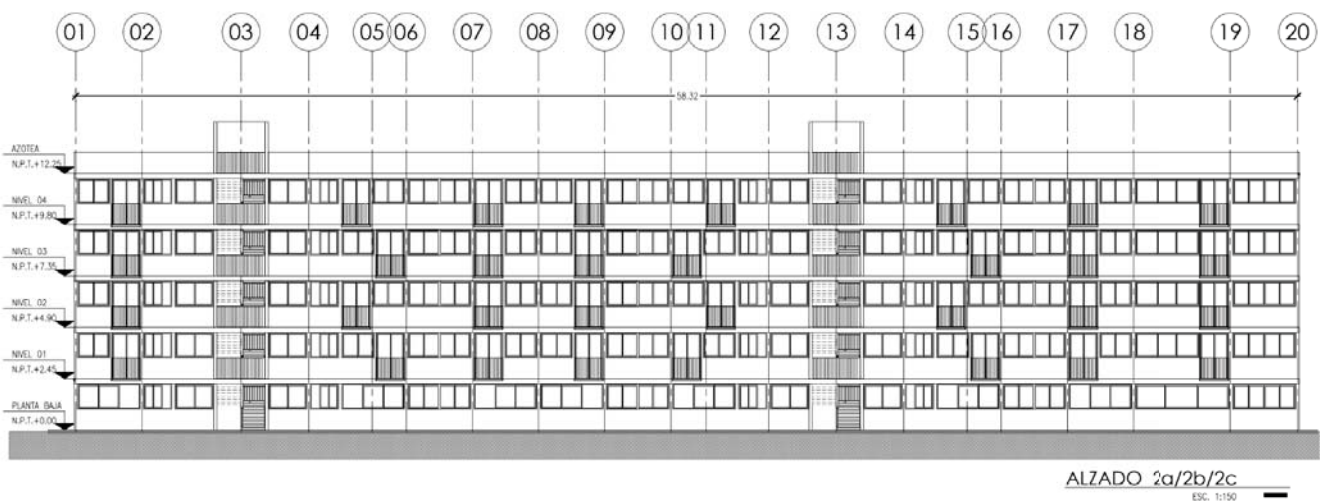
Fachada tipo del edificio 2A, 2B Y 2C
